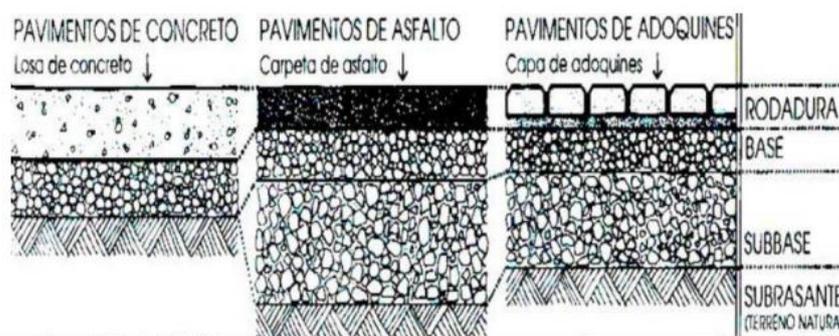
Partes estructurales de un Pavimento de adoquines (ASCE,2010)
